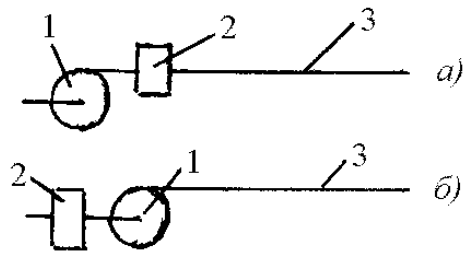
Варіанти розміщення нагрівача опалювальної системи: а – після вентилятора; б – перед вентилятором. 1 – вентилятор; 2 – нагрівач; 3 – вентиляційна мережа
